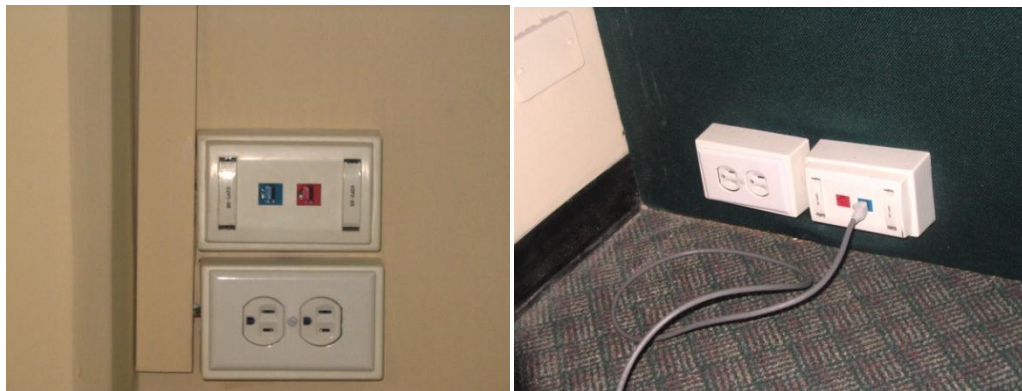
Cajas sobrepuestas y face plate en las estaciones de trabajo
